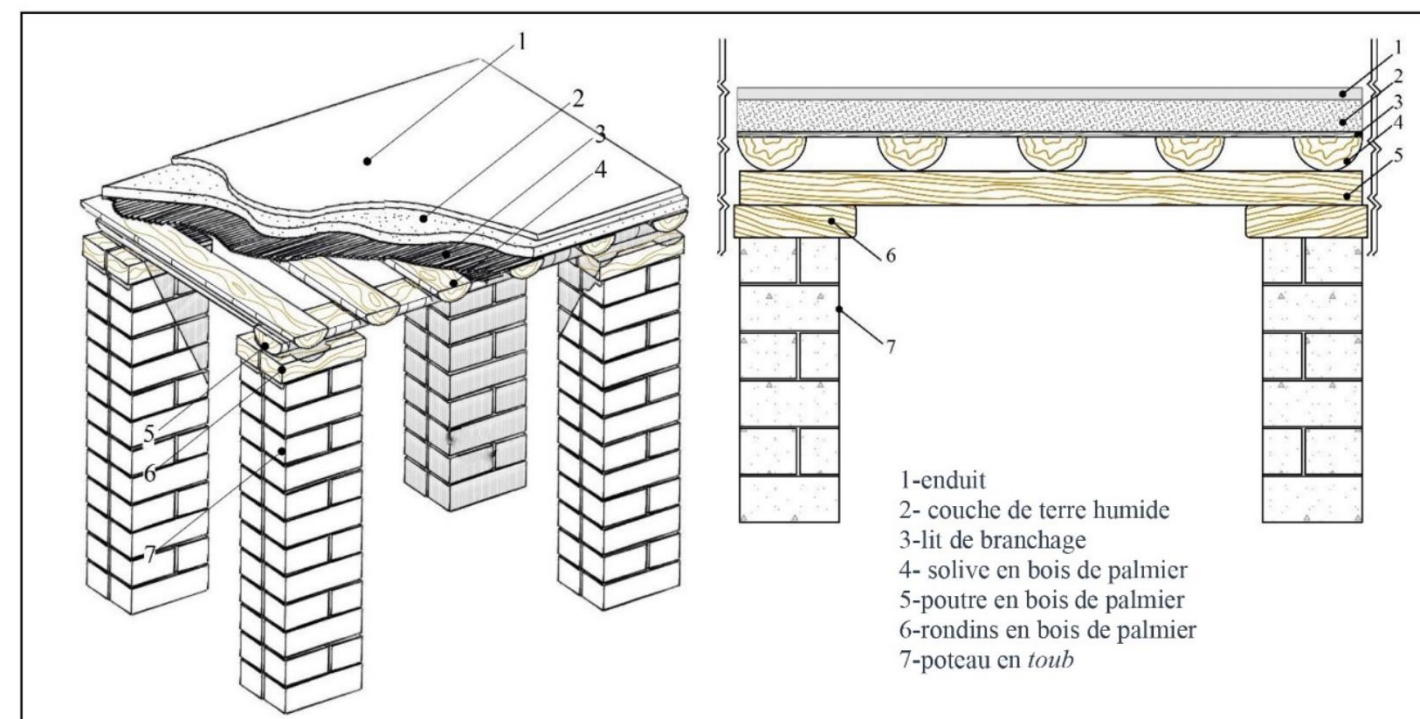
axonométrie et coupe verticale du plancher traditionnel placé sur des poteaux
